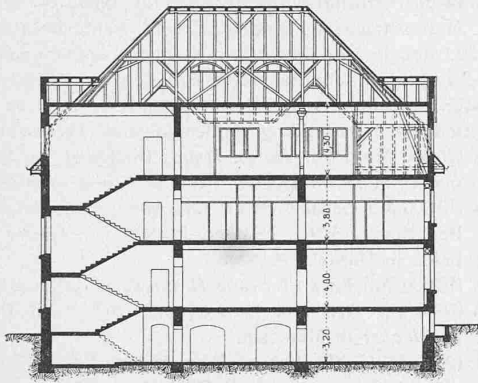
und 3. Schnitt und Grundrisse. — 1 : 400.
